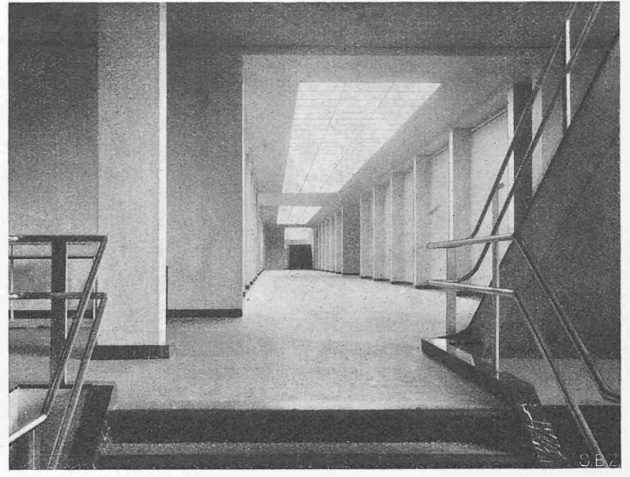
Haupt-Längsgang im Erdgeschoss.
